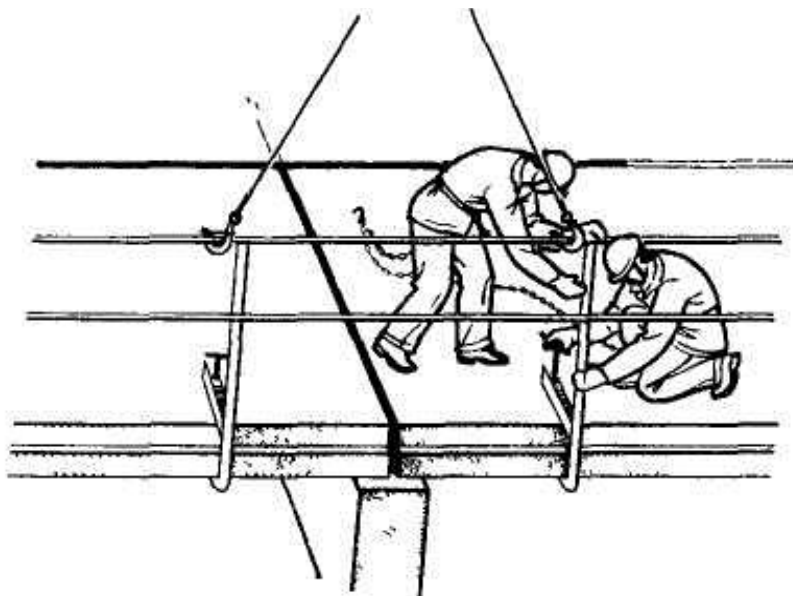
Укладка и анкеровка плиты перекрытия.
